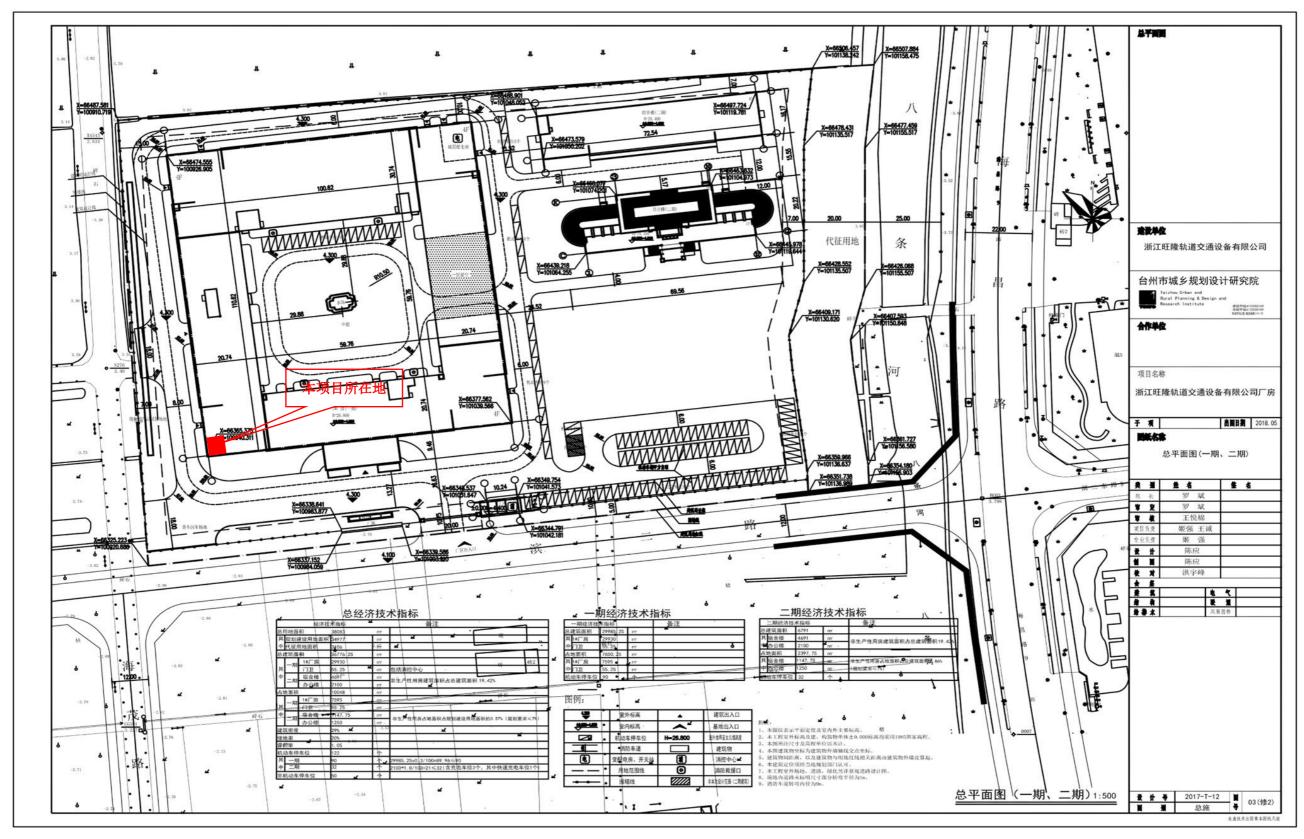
浙江旺隆轨道交通设备有限公司总平面布置图
